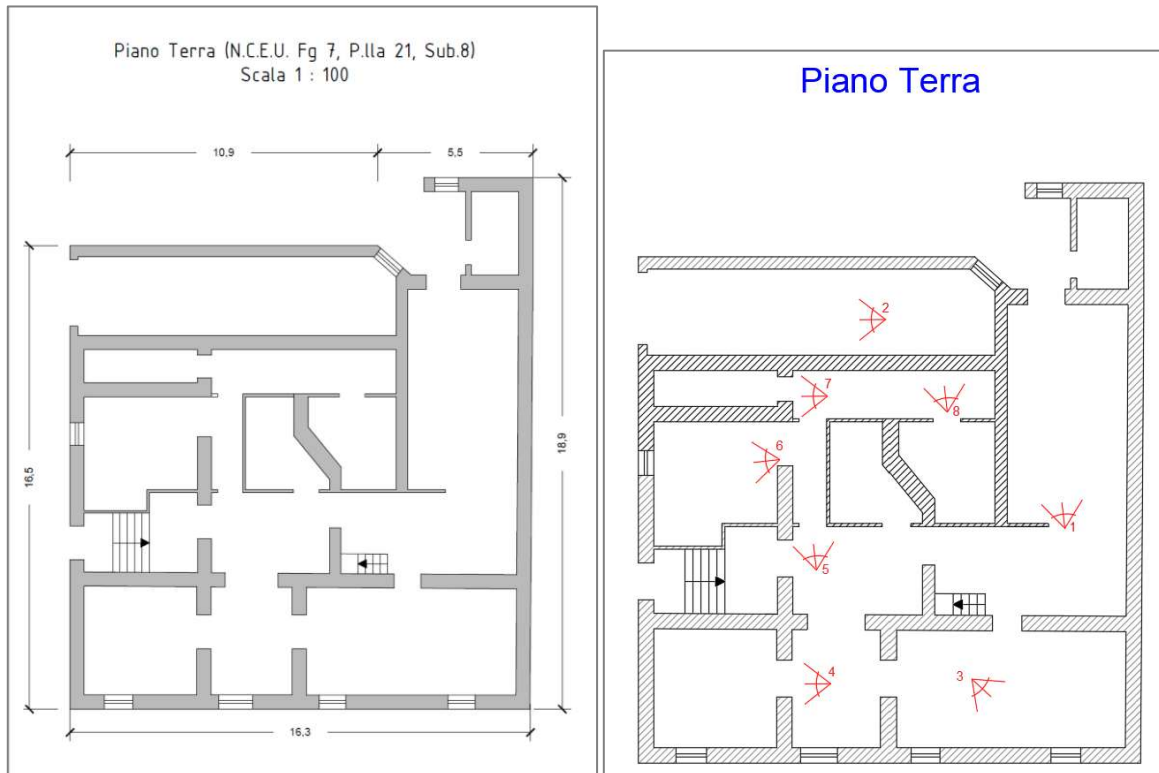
e 14- Pianta piano terra e pianta con coni ottici
